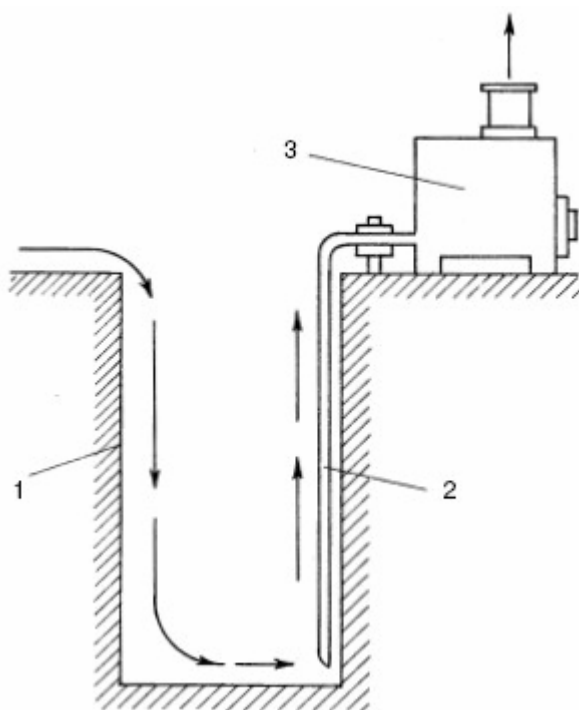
Вариант вентиляции шахты колодца с помощью переносной печи: 1 – шахта колодца; 2 – вентиляционная труба; 3 – переносная печь
